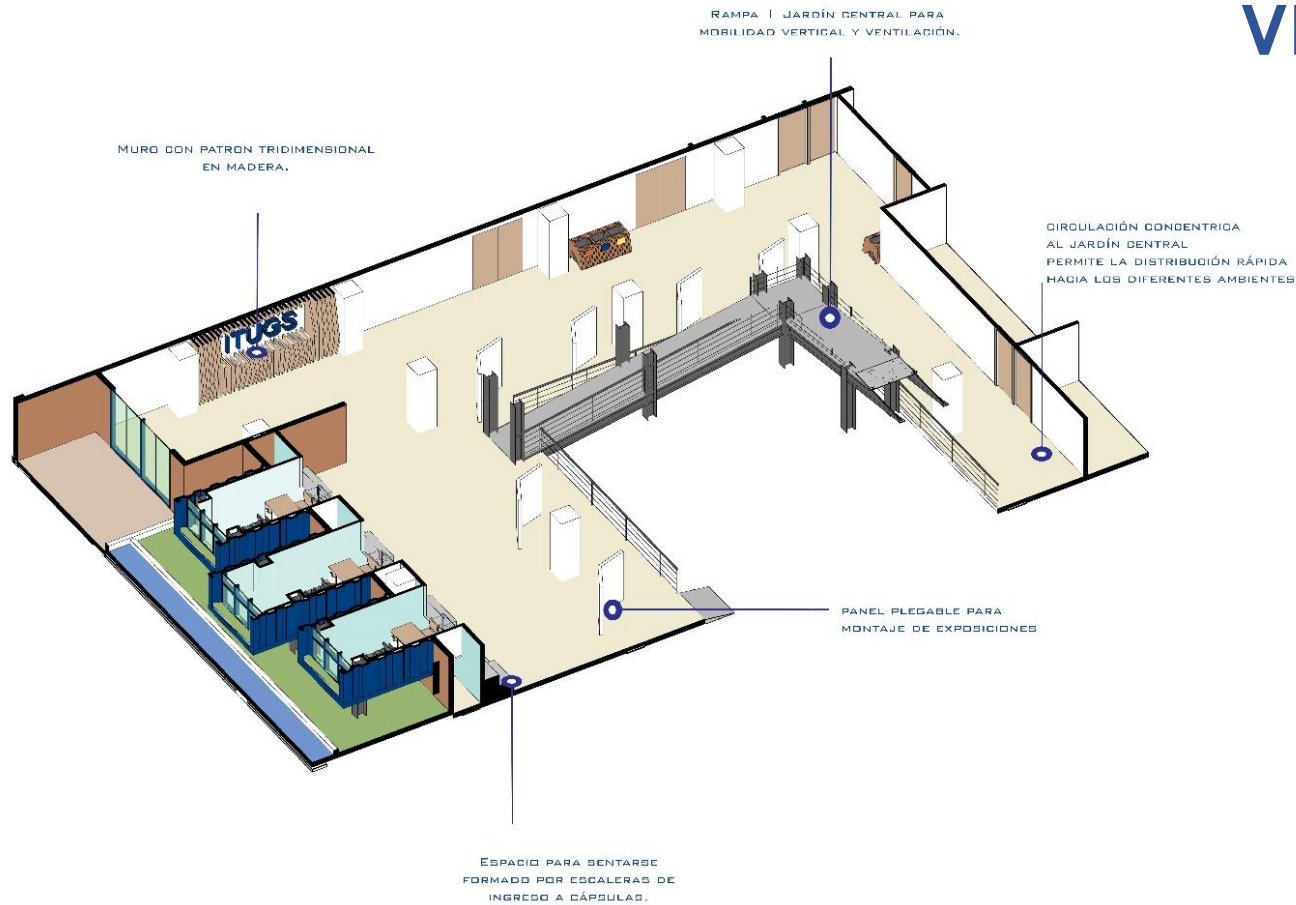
Detalle 3D de área de exposición. Fuente: Elaboración propia.
